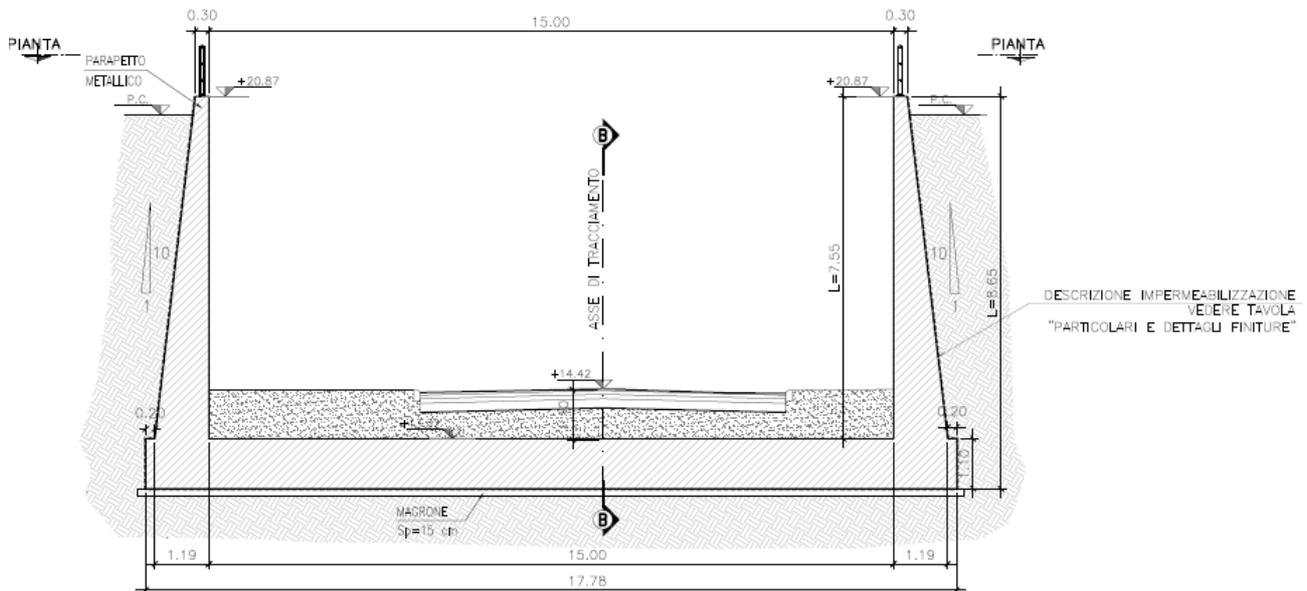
Muro di sbocco/imbocco - Sezione trasversale
